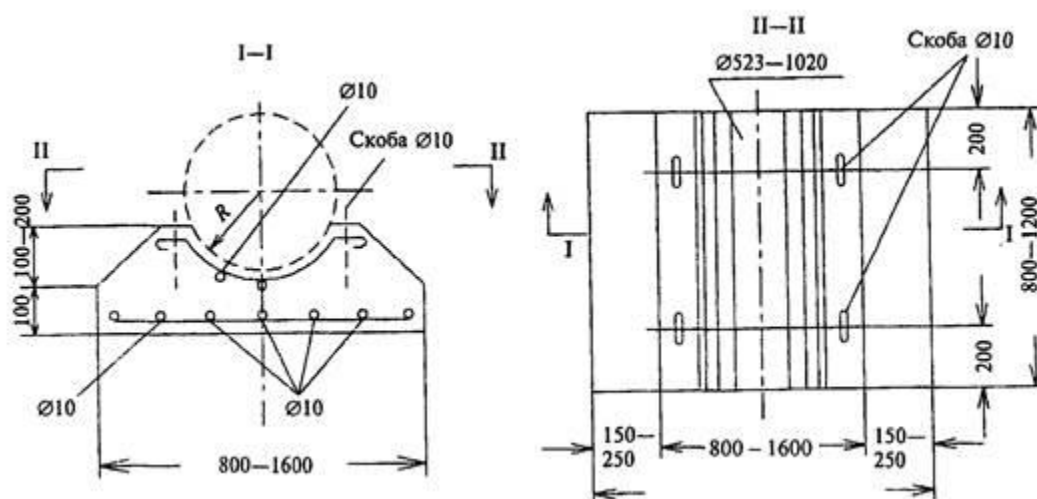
Плитная опора с ложем для укладки трубопровода
